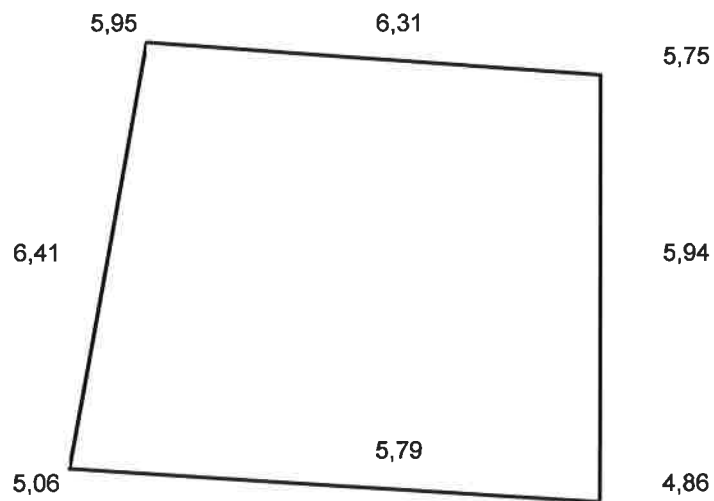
Skizze des Grundrisses mit Angaben der Maße des Hallraumes der TU Berlin
